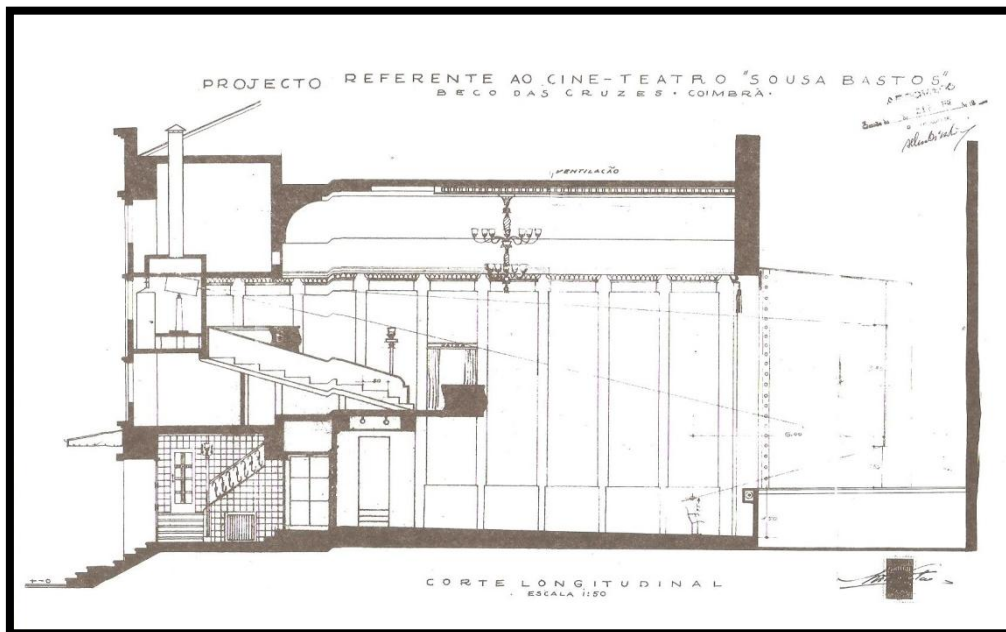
Corte Longitudinal – Planta do Sousa Bastos.
